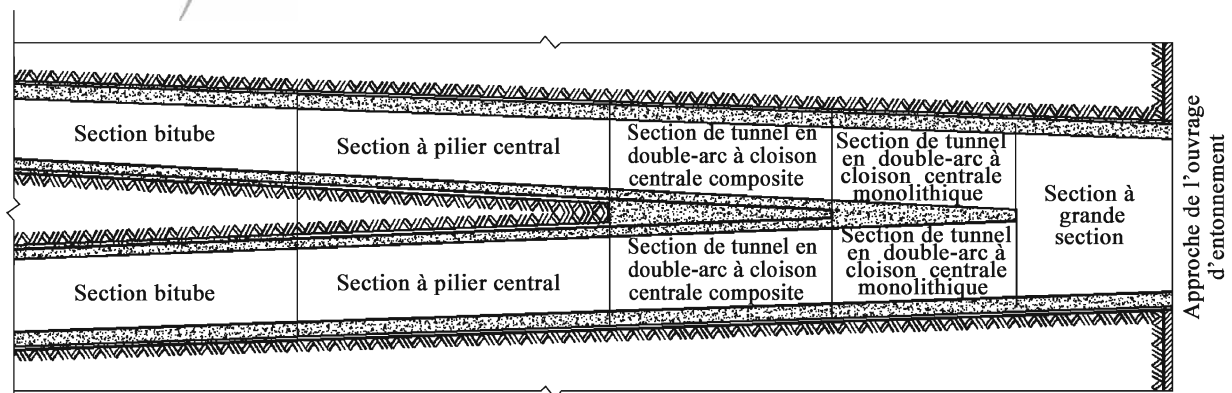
Disposition en plan du revêtement d'ouvrage d'entonnement de type I
